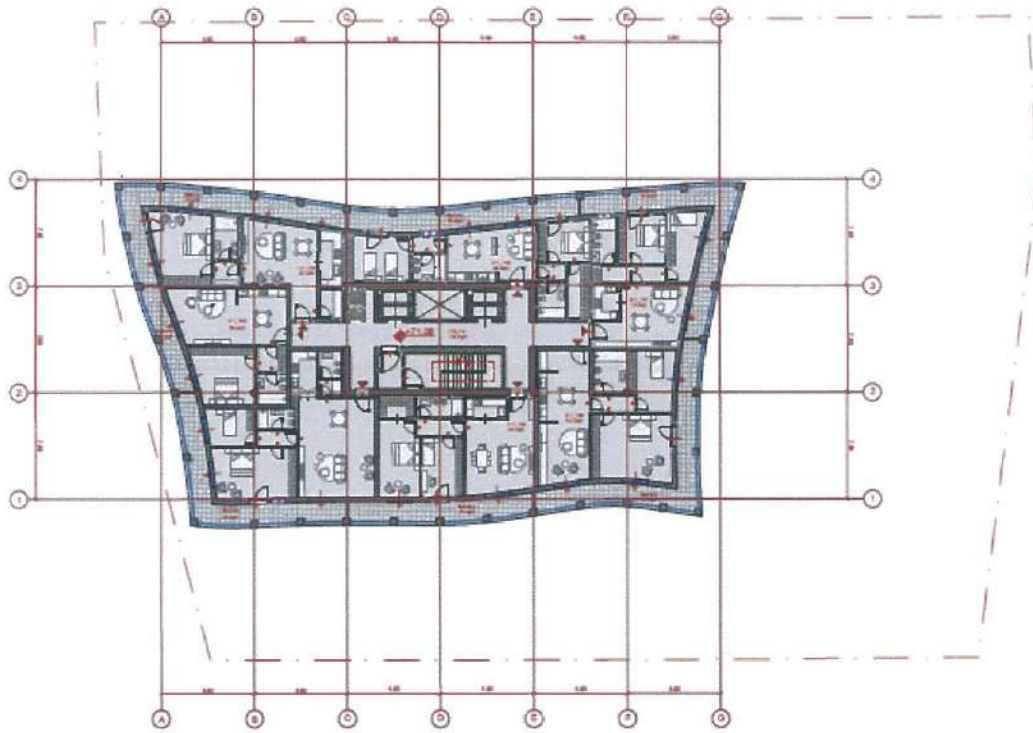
Planimetria e katit 18, në kuotën +71.06 SIP 964 m²
